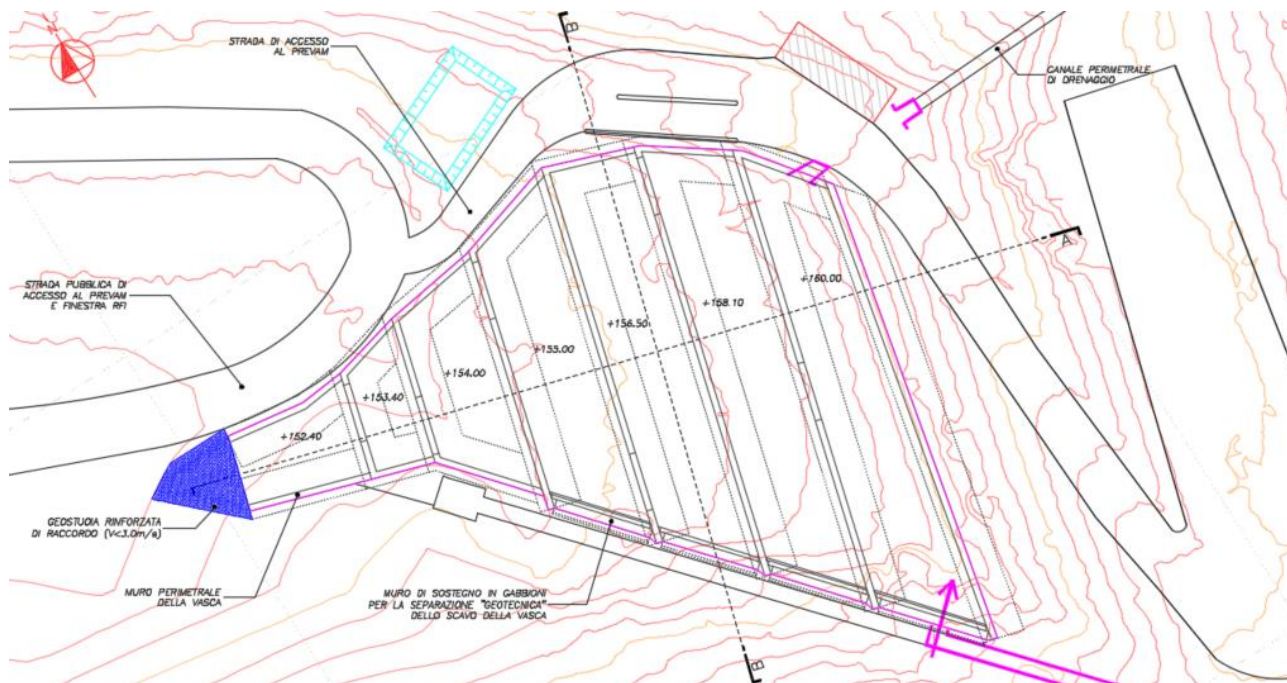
VISTA PLANIMETRICA DELLA VASCA DI SEDIMENTAZIONE
